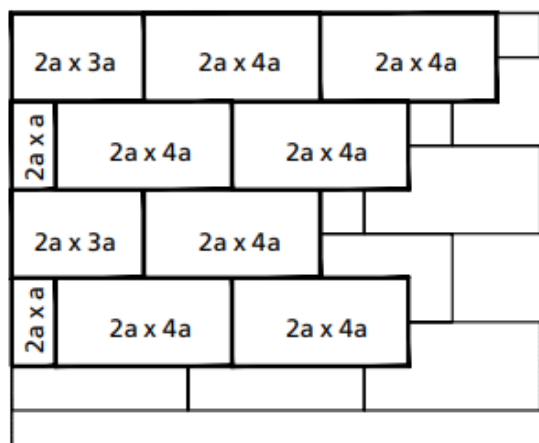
Схема укладки второго (верхнего) слоя теплоизоляции
